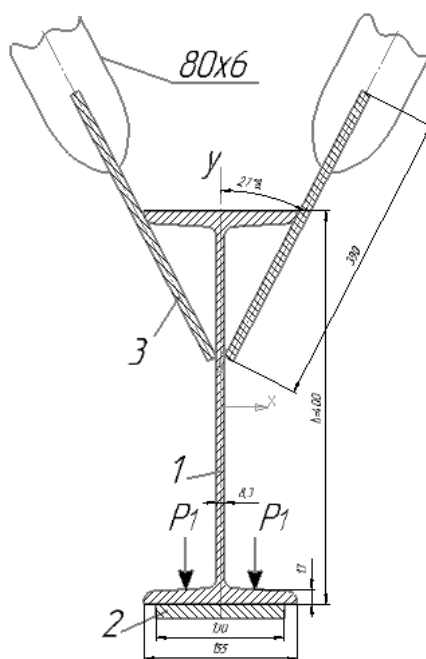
Поперечний перетин нижнього поясу прогінної будови
